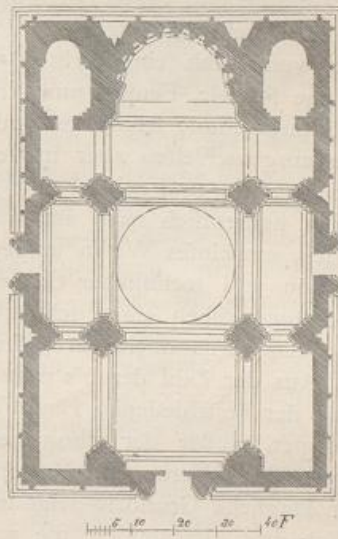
Kathedrale zu Ani (Grundriss).
